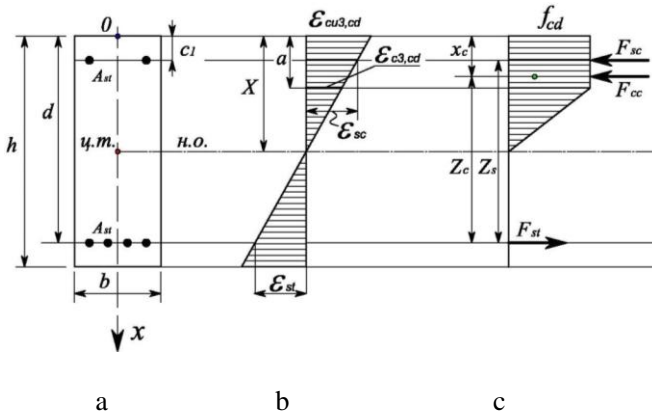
Схемы распределения относительных деформаций и усилий при расчете прямоугольного сечения с двойным армированием:
